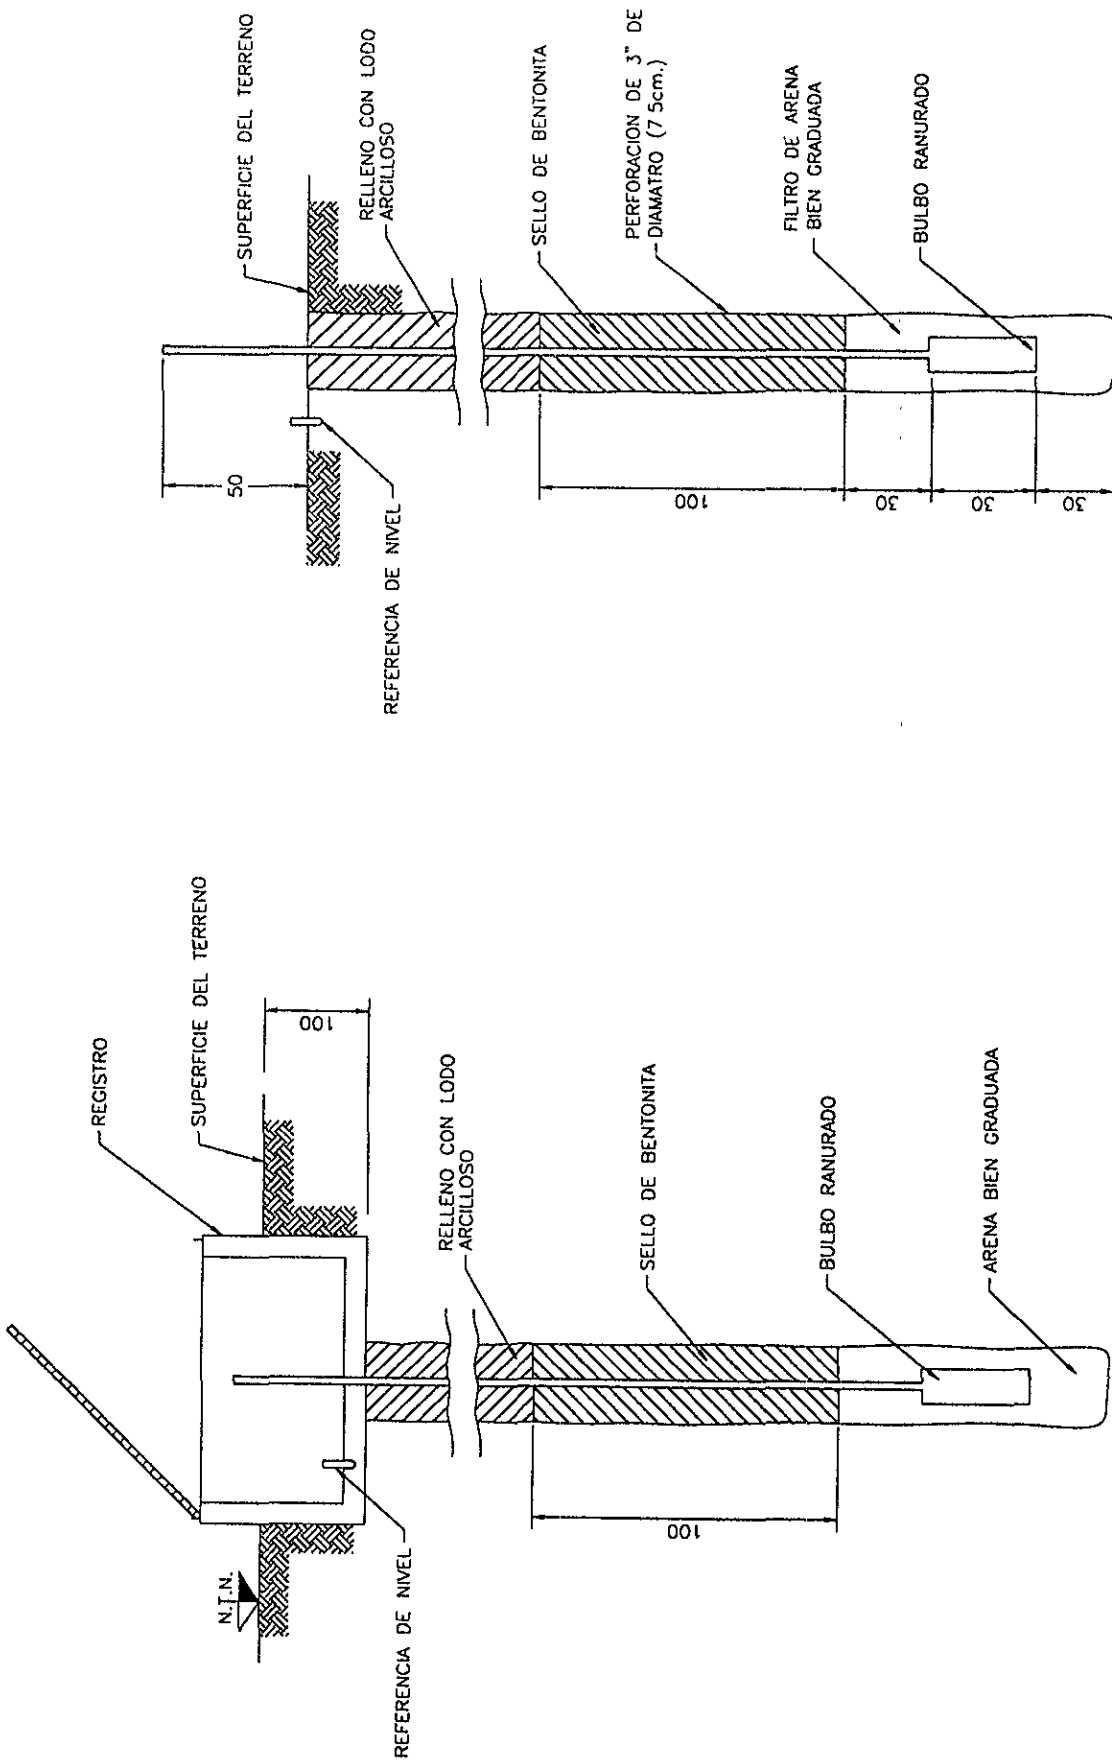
INSTALACIÓN DEL PIEZÓMETRO
